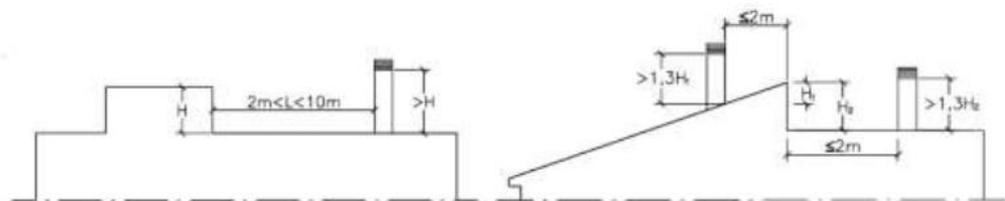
Ejemplos de altura libre del extremo superior de la bajante sobre la cubierta
